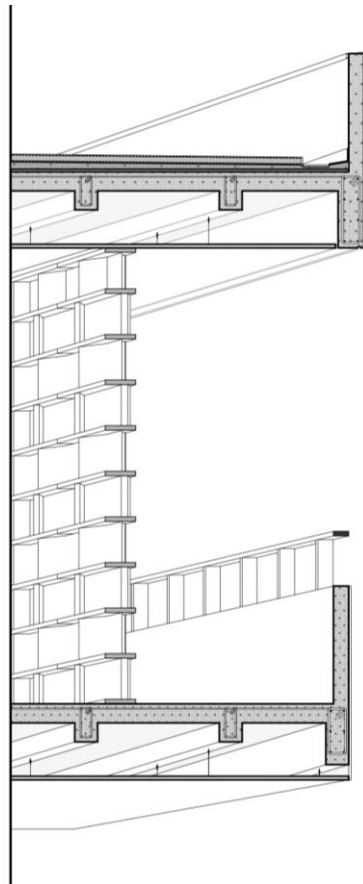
Detalle arquitectónico balcones. Elaboración propia
